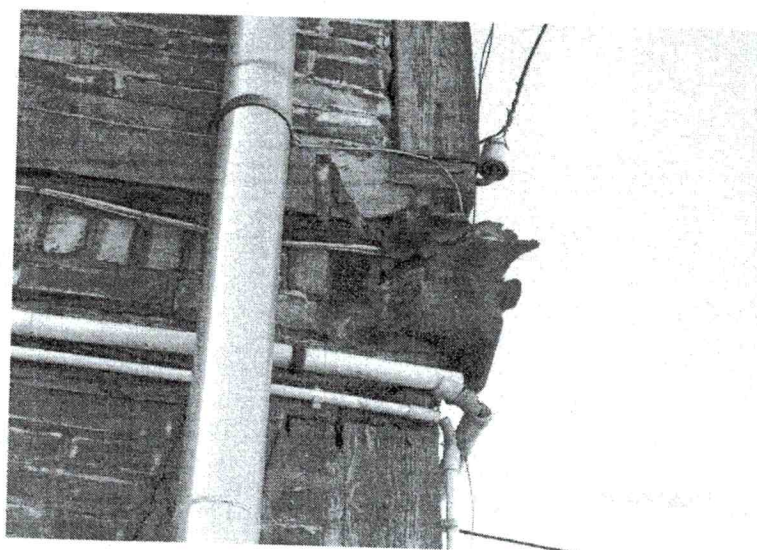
Ubytki drewna uzupełnione pianką poliuretanową.
